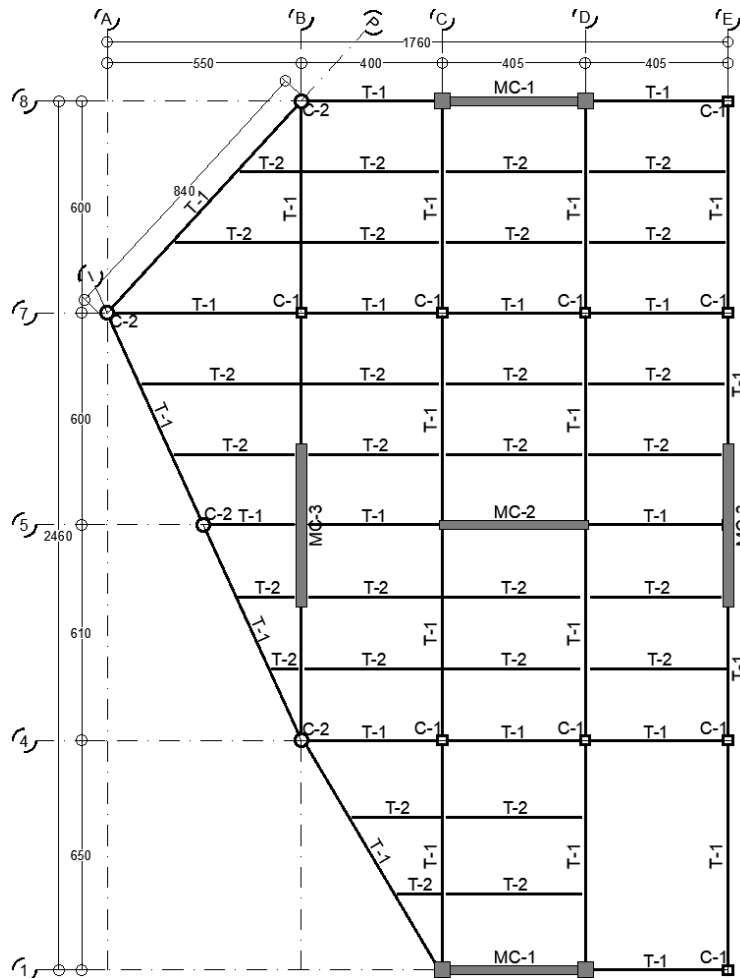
Esquema de la planta estructural tipo - propuesta 2
